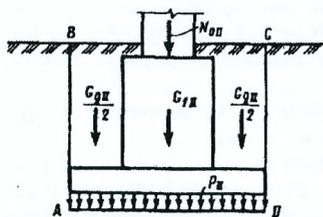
Расчетная схема центрально нагруженного фундамента
